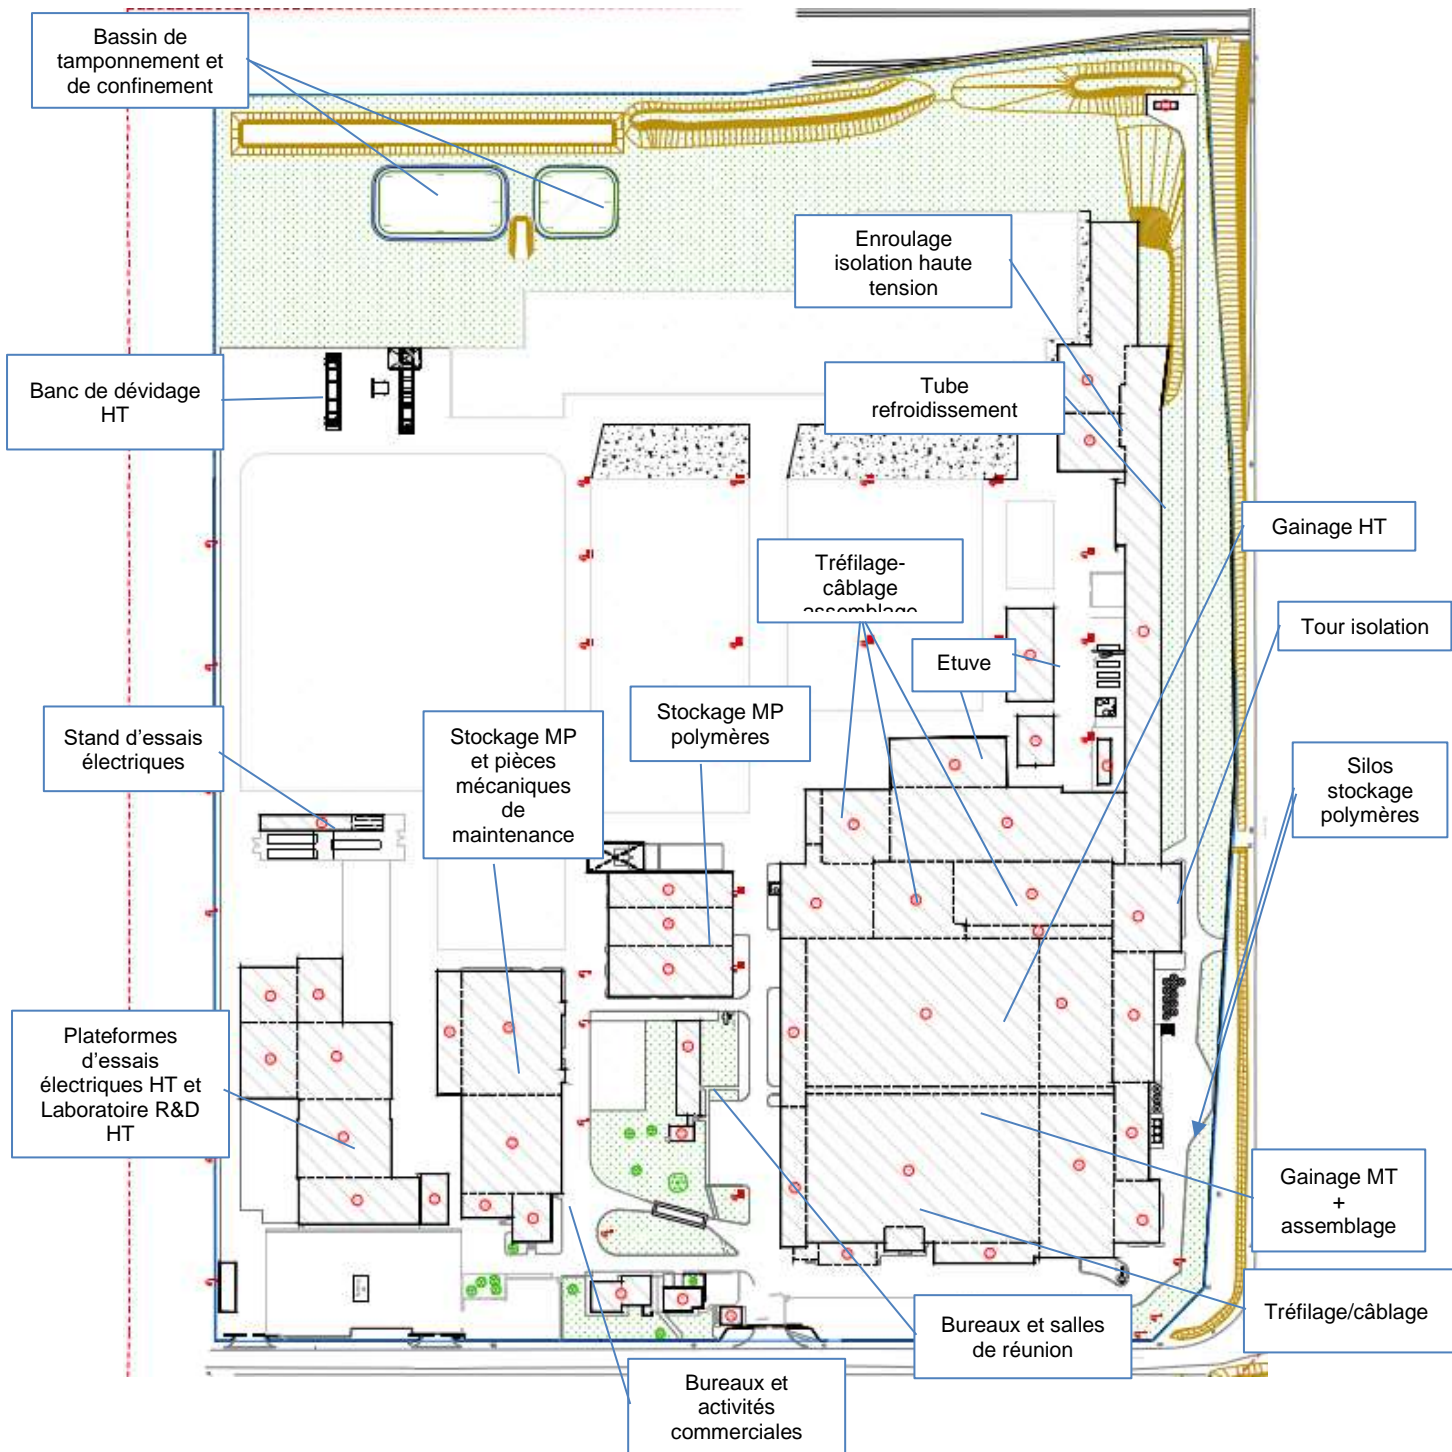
Plan de masse existant (source : PRYSMIAN)
